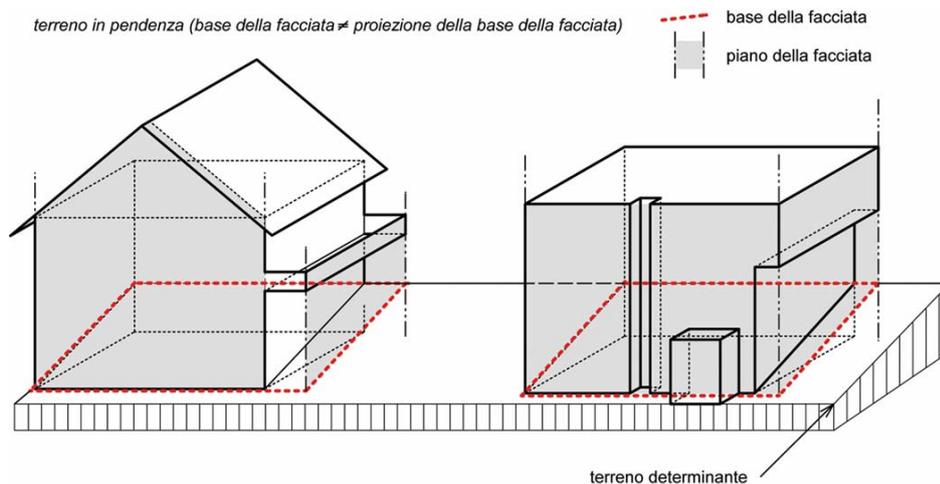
3.3 Piano della facciata e base delle facciate
